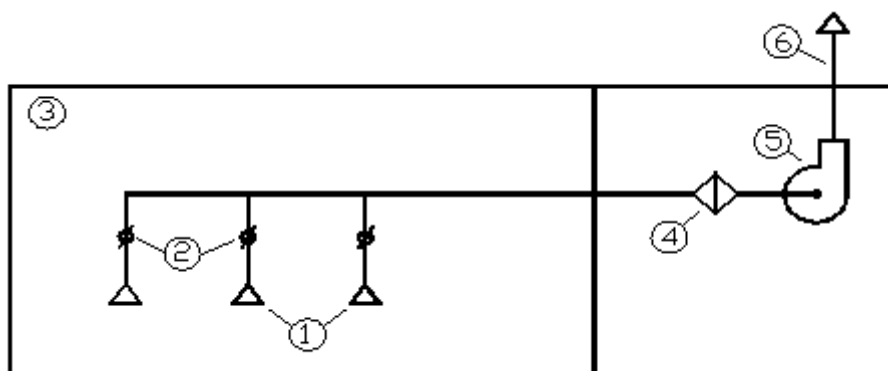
Схема вытяжной системы местной вентиляции (Учебник «Пожарная безопасность в строительстве» Часть 1 пожарная безопасность систем отопления и вентиляции): 1 - воздуховытяжное устройство; 2 - дроссель-клапан; 3 - обслуживаемое помещение; 4 - фильтр очистки удаляемого воздуха; 5 - вентилятор; 6 - вытяжная шахта (труба)
